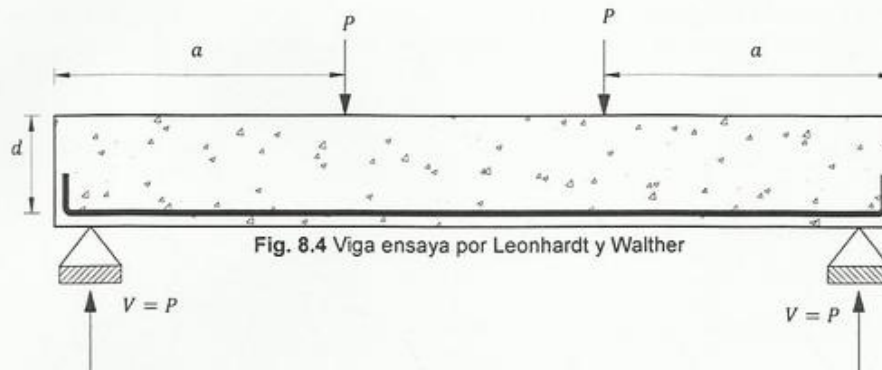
Viga ensaya por Leonhardt y Walther
